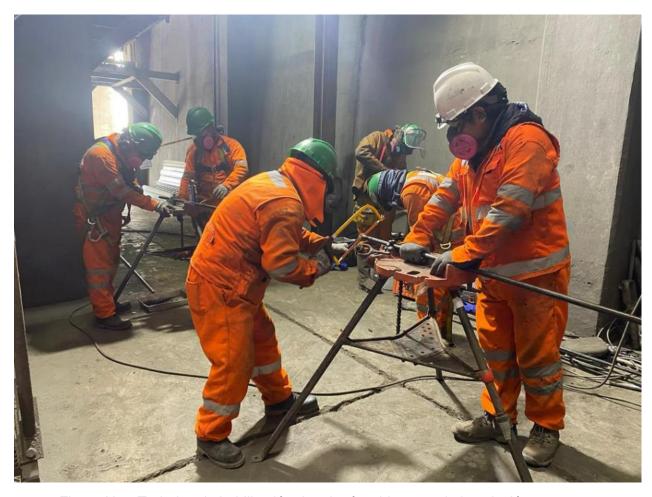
Trabajos de habilitación de tubería tubing para la instalación.
